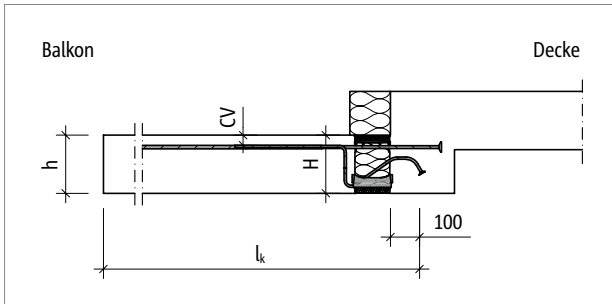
Schöck Isokorb® XT Typ KL-U: Statisches System
